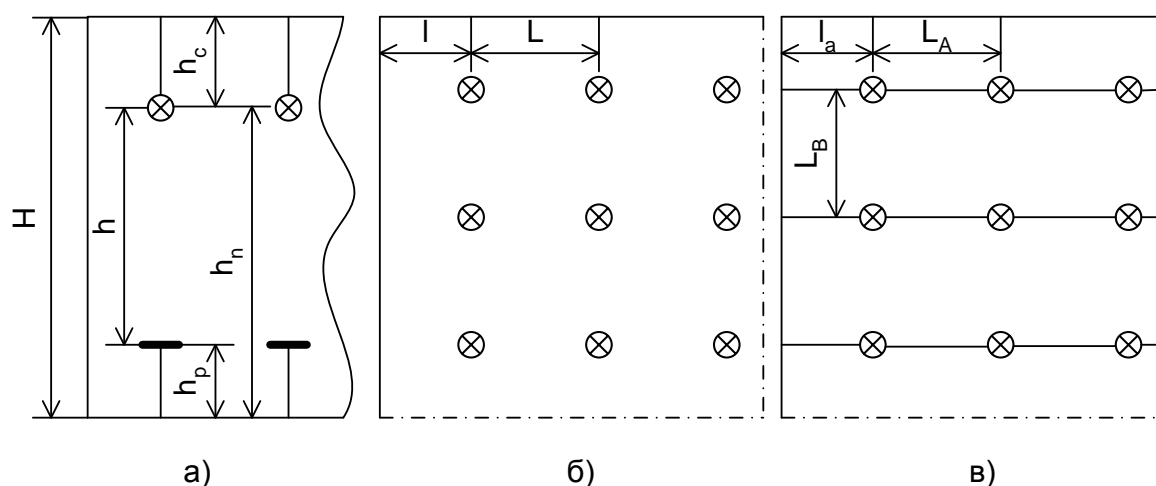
Схемы расположения светильников в разрезе и в плане.
